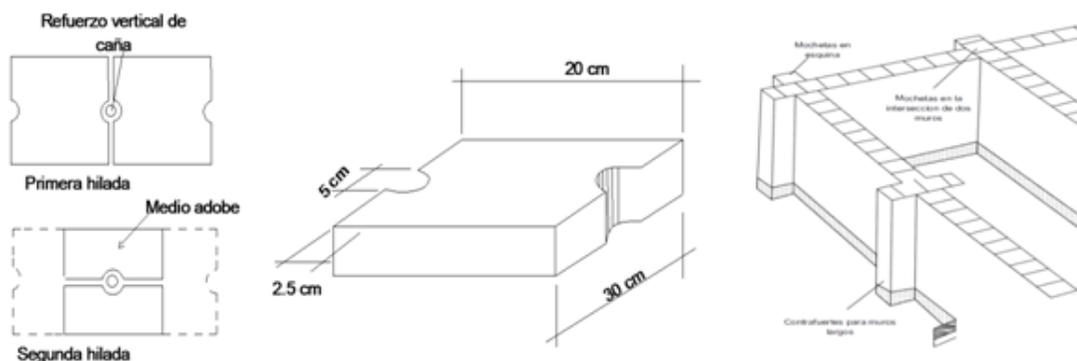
Dimensionamiento, traslape y refuerzos del adobe. Elaboración propia
